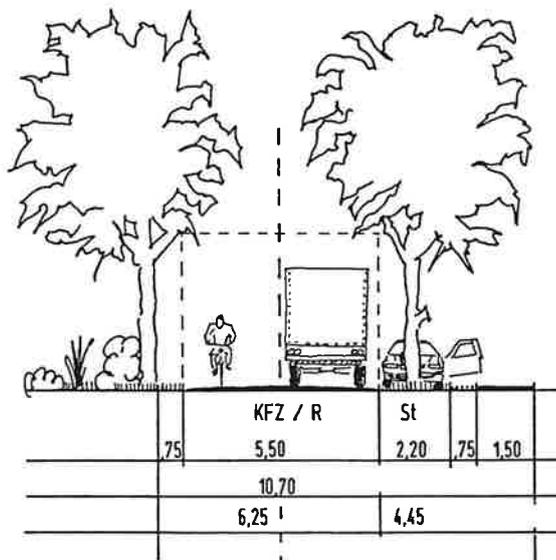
SCHNITT D-D, PLANSTRASSE D, PLANSTRASSE E
